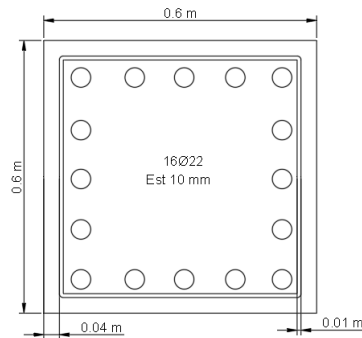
Detalle de vigas secundarias 5 Pisos
